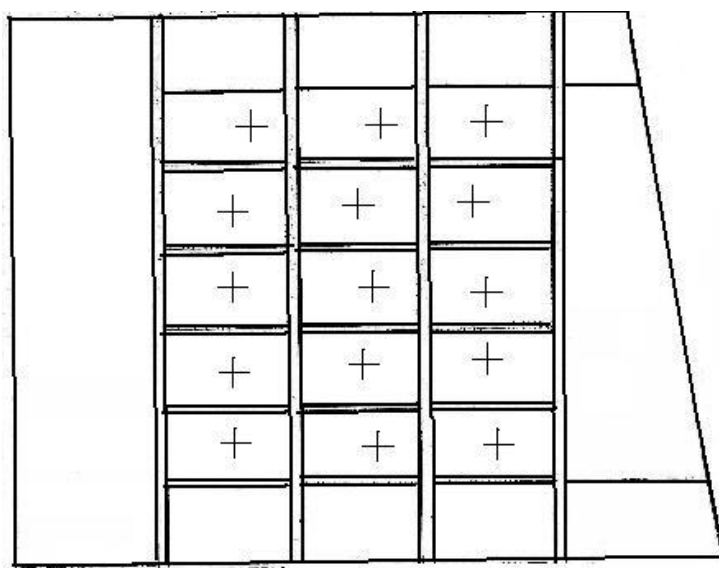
Planta da laje da cobertura com a respectiva disposição da armadura
